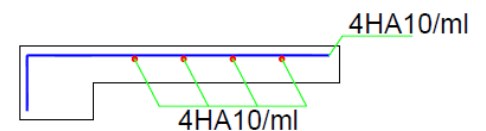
Ferrailage en appui de la dalle pleine d'ascenseur
